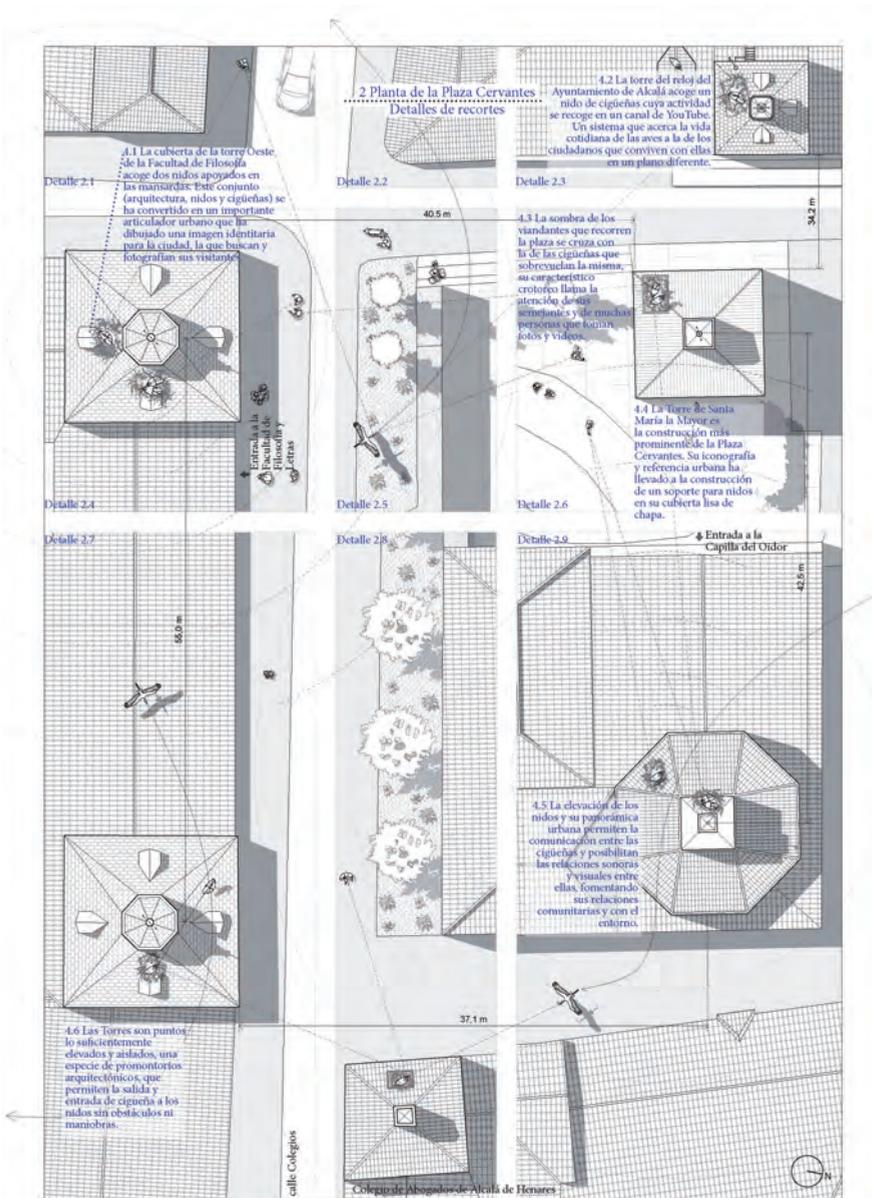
Lámina 4. Planta de la Plaza Cervantes. Detalles de recortes. Elaboración de los autores, 2023.
